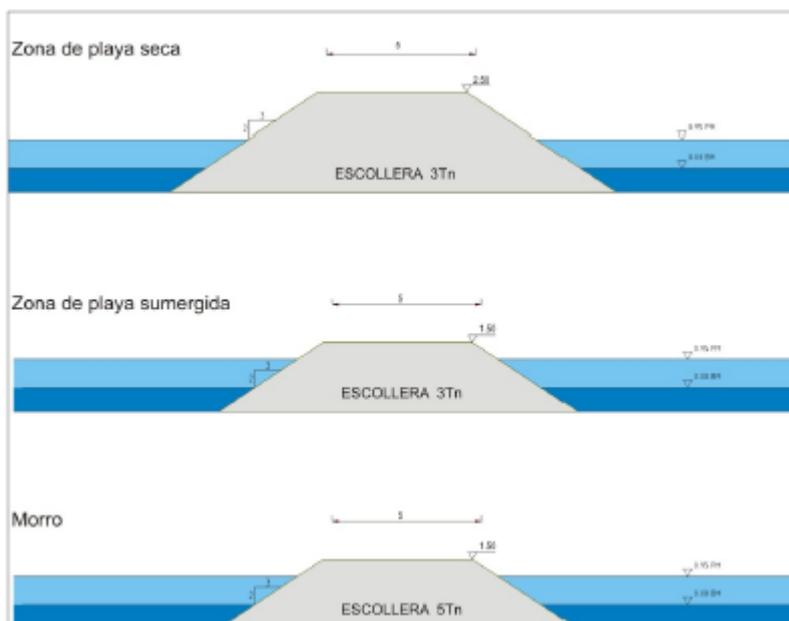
Secciones tipo del espigón. Fuente: HIDTMA
